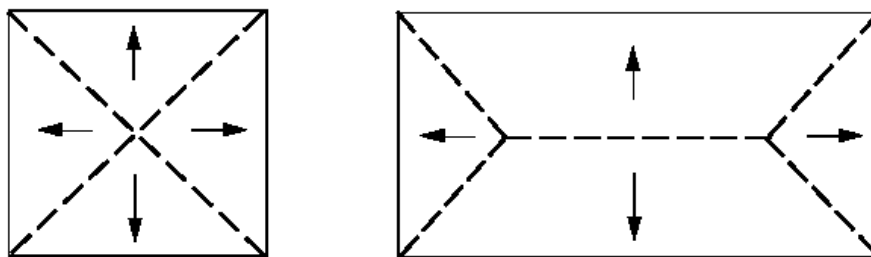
Delimitación de Áreas de Aportación a cada Tramo
